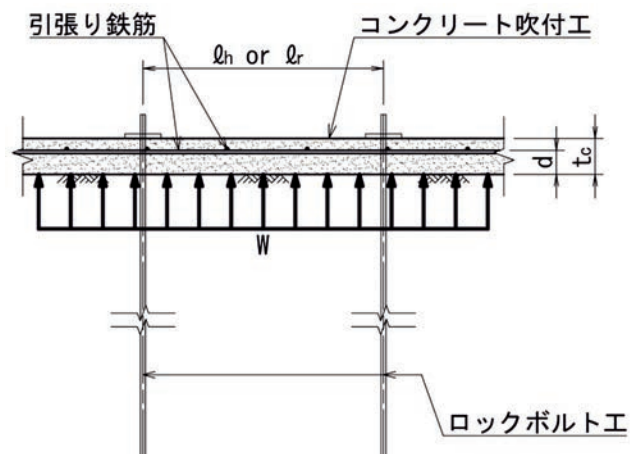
コンクリート吹付工に作用する等分布荷重の考え方（断面図）
